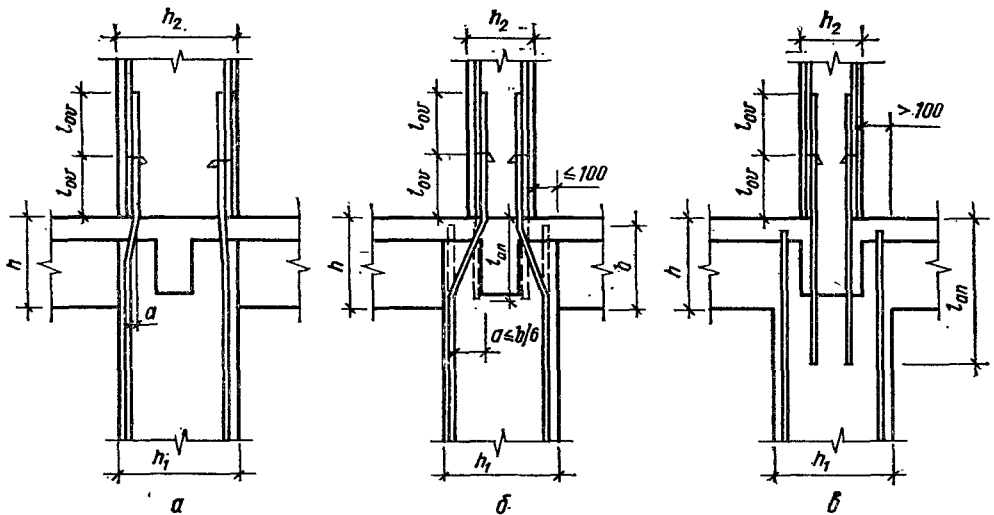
Схема устройства стыков продольных стержней монолитных колонн многоэтажных зданий:
